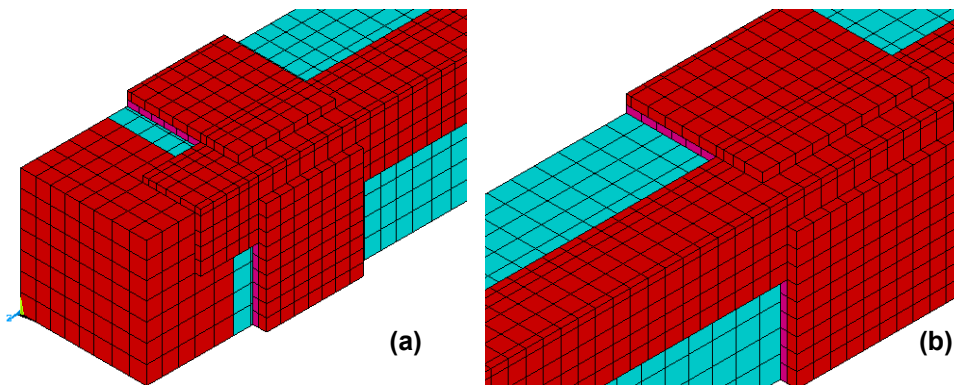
(a) Detalle de la unión de los angulares con los extremos de la probeta. (b) Vista de la capa de mortero de cemento entre el hormigón del tramo de soporte y las presillas
